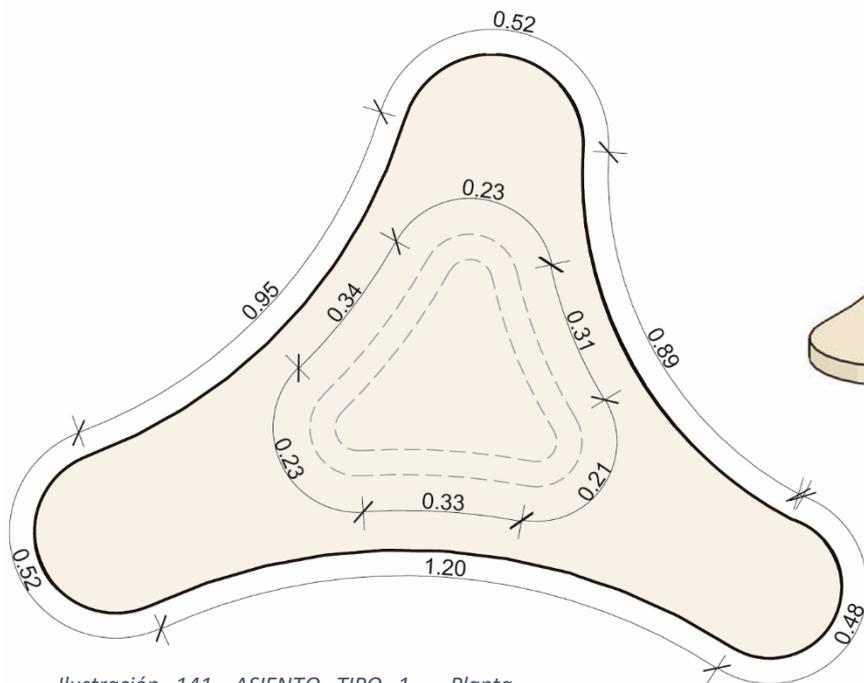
ASIENTO TIPO 1 - Planta arquitectónica.
